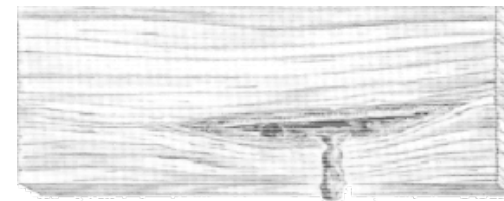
Bolsa de resina (Fuente: TFMB, 2014).
